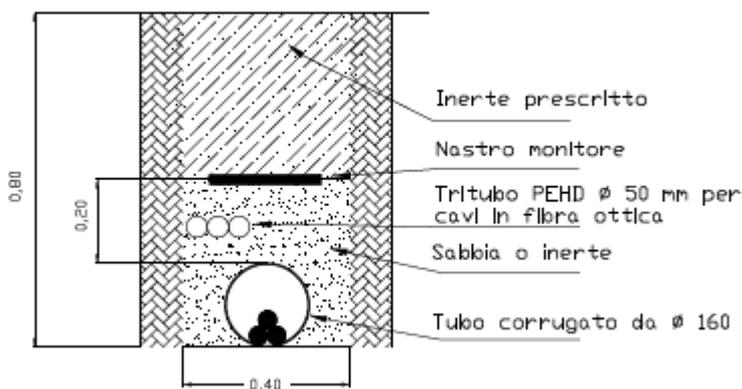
Sezione su strada sterrata o terreno agricolo - posa di n°1 cavo MT
